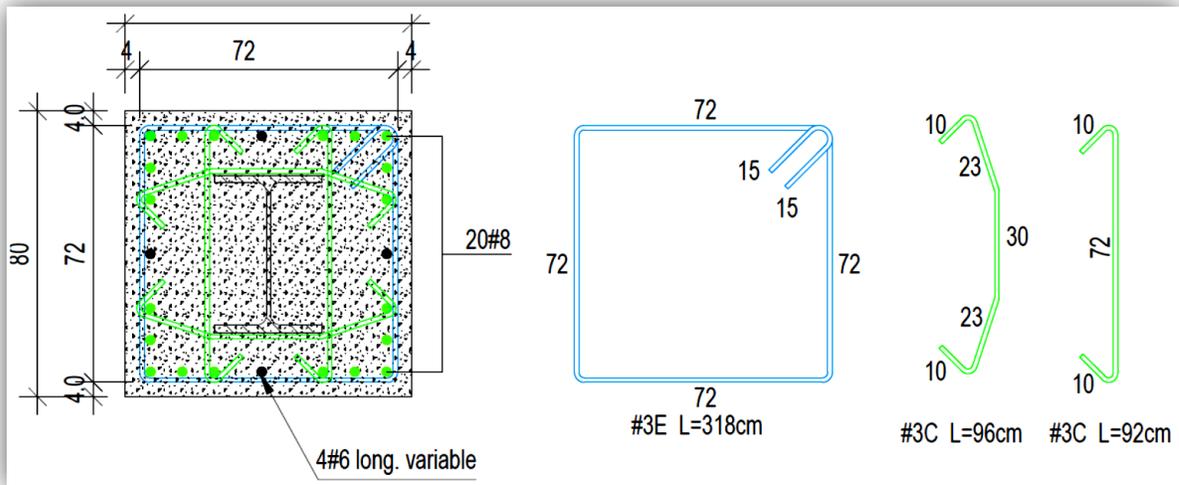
Refuerzo transversal de las columnas de 0.80 m x 0.80 m.
